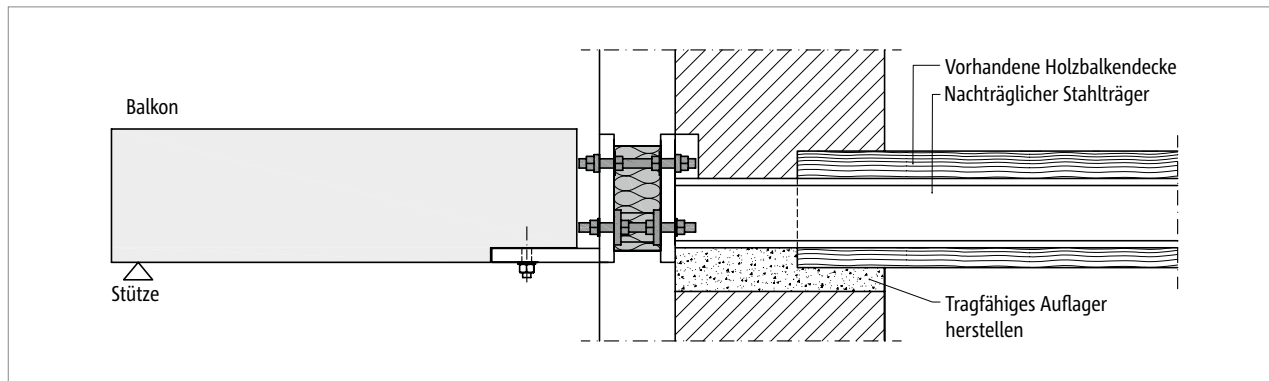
Schöck Isokorb® T Typ S: Fertigteilbalkon gestützt; angeschlossen an Holzbalkendecke
